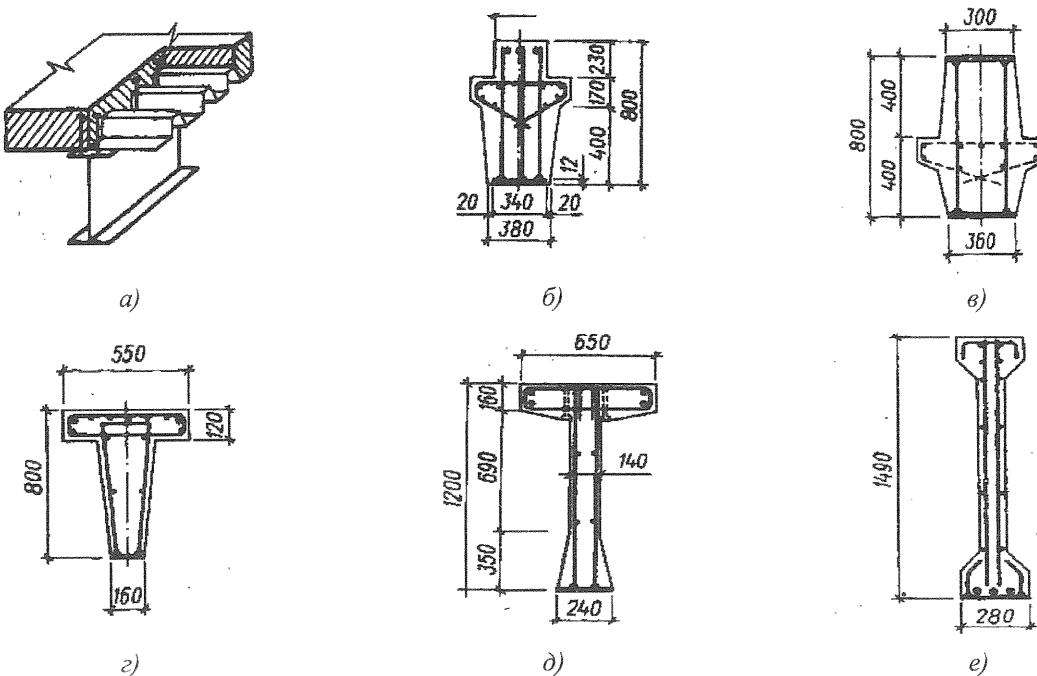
Поперечні перерізи сталебетонних балок із зовнішнім армуванням:
